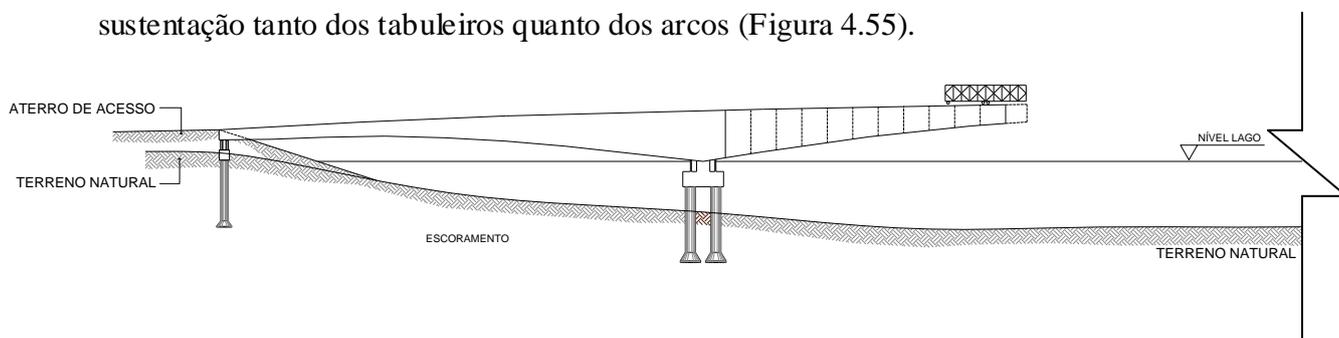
Fase da Construção 03, exemplo da construção em balanço sucessivo, para maior detalhe conferir a Figura 5.9. Fonte: (DE – DVO – NOVACAP, 1969).
